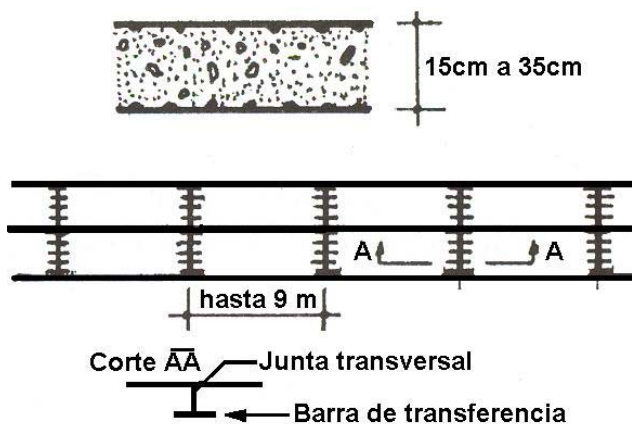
Pavimentos de Concreto Simple, con Pasadores.
